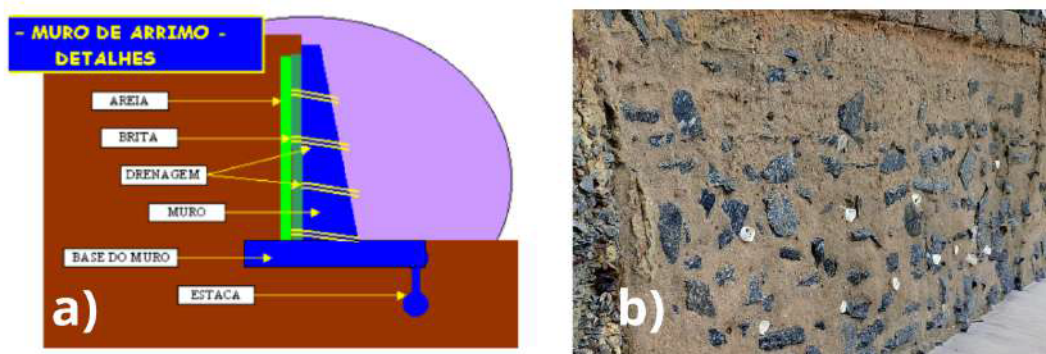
a) e b) Muro de arrimo na praia da Ponta Verde.
